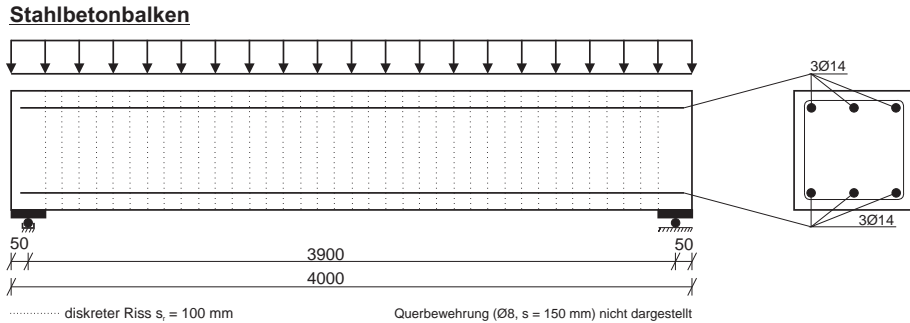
Skizze modellierter Stahlbetonbalken RC-C20
